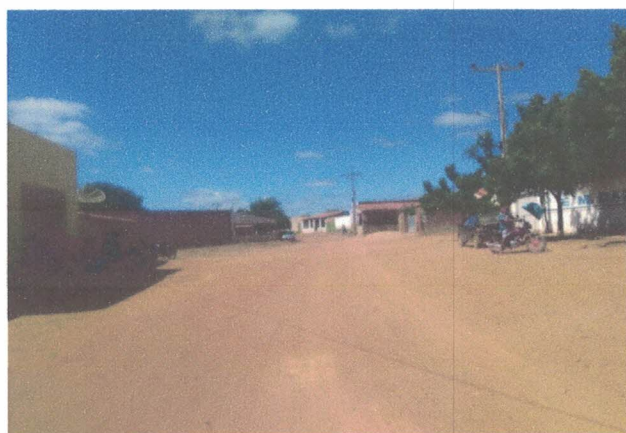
RUA PROJETADA - TRECHO 2
